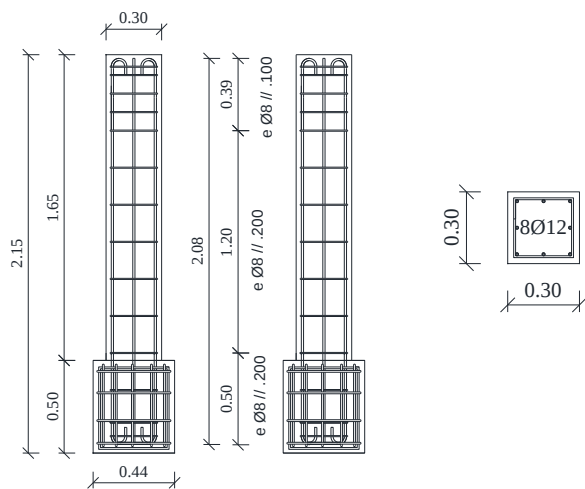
Geometria e pormenores da armadura dos pilares com armadura lisa.
